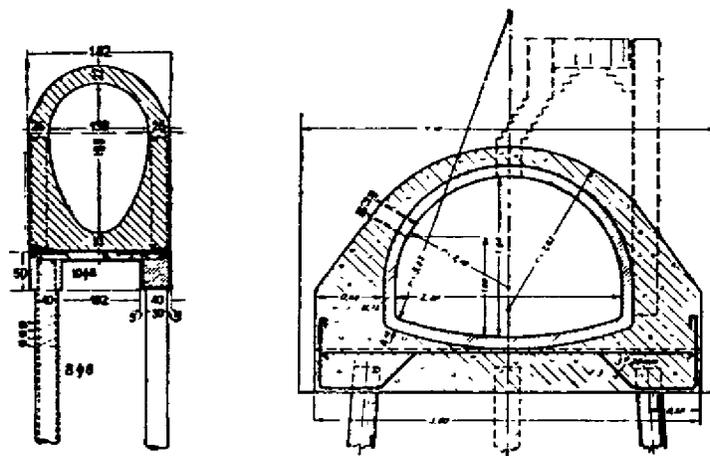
14: Colocación de tuberías sobre pilotes
